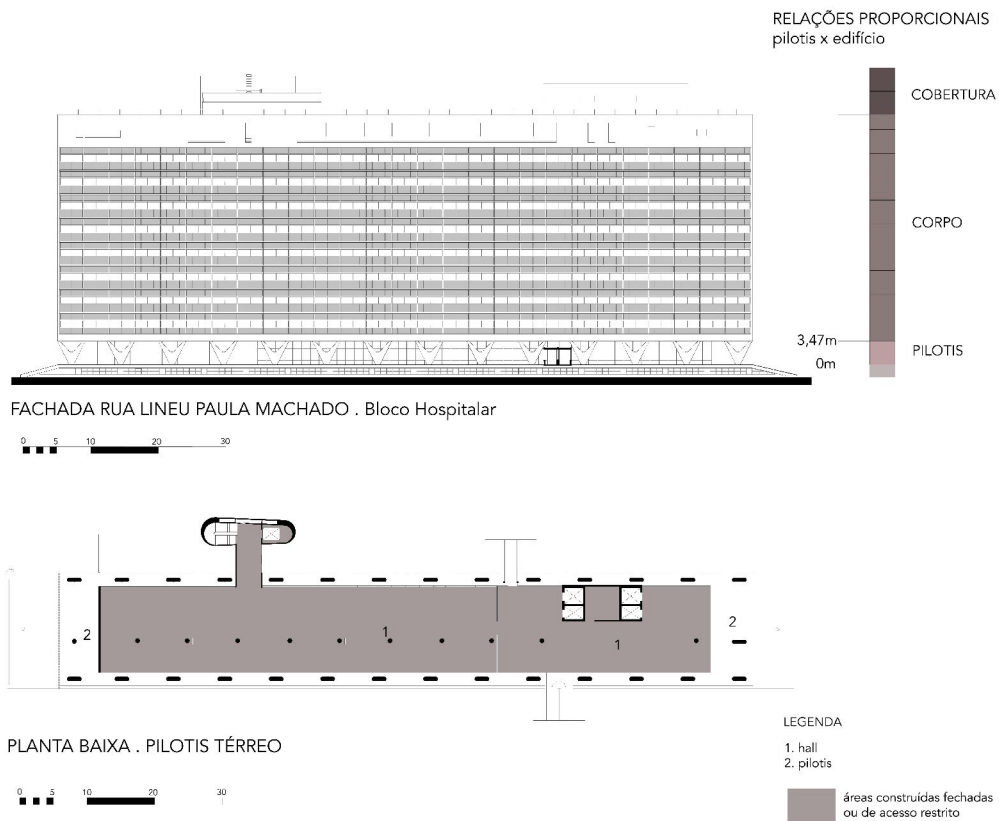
Planta baixa do nível térreo e fachada frontal do bloco hospitalar sobre pilotis. Fonte: edição da autora sobre desenhos do acervo da Astorga Arquitetura e Restauo e Technische Engenharia<sup>41</sup>, 2020.
